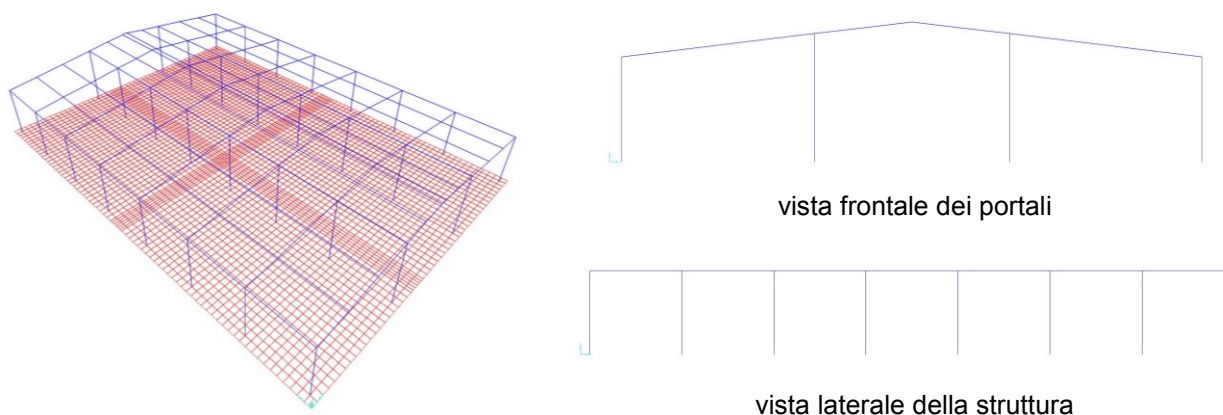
Schema ipotizzato per il calcolo della platea di fondazione
